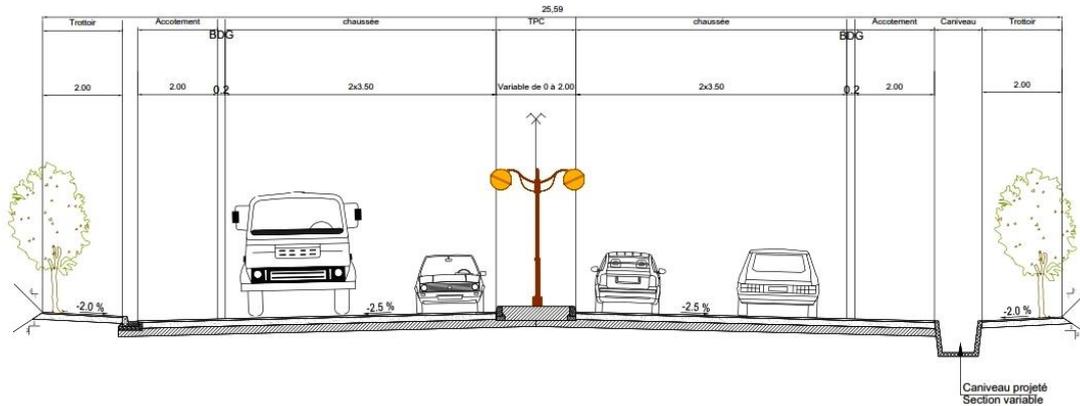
Proposition d'aménagement de la traversée des agglomérations (variante 1)
